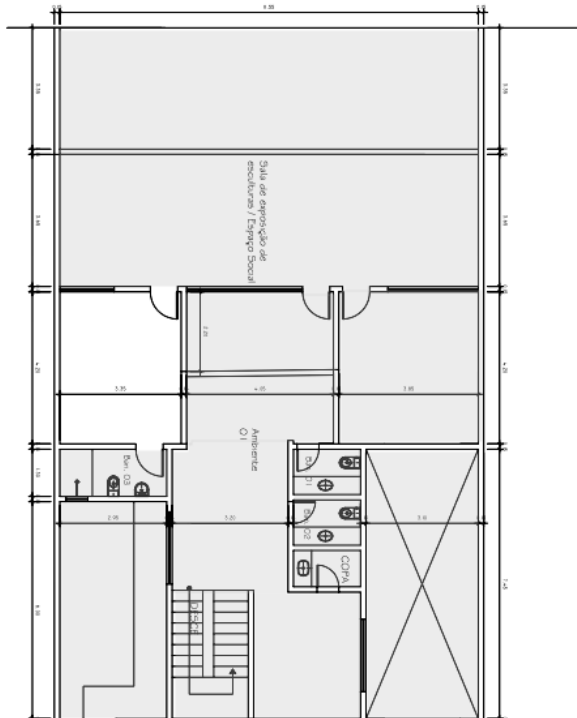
Planta baixa da Galeria do Largo - Pavimento 2.
